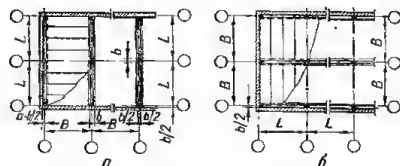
Привязка стен к разбивочным осям в зданиях с несущими стенами при конструктивной схеме:
